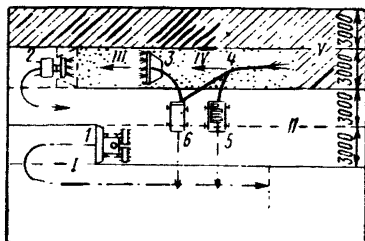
Схема организации гидроизоляционных работ на открытом воздухе без применения тепляков
